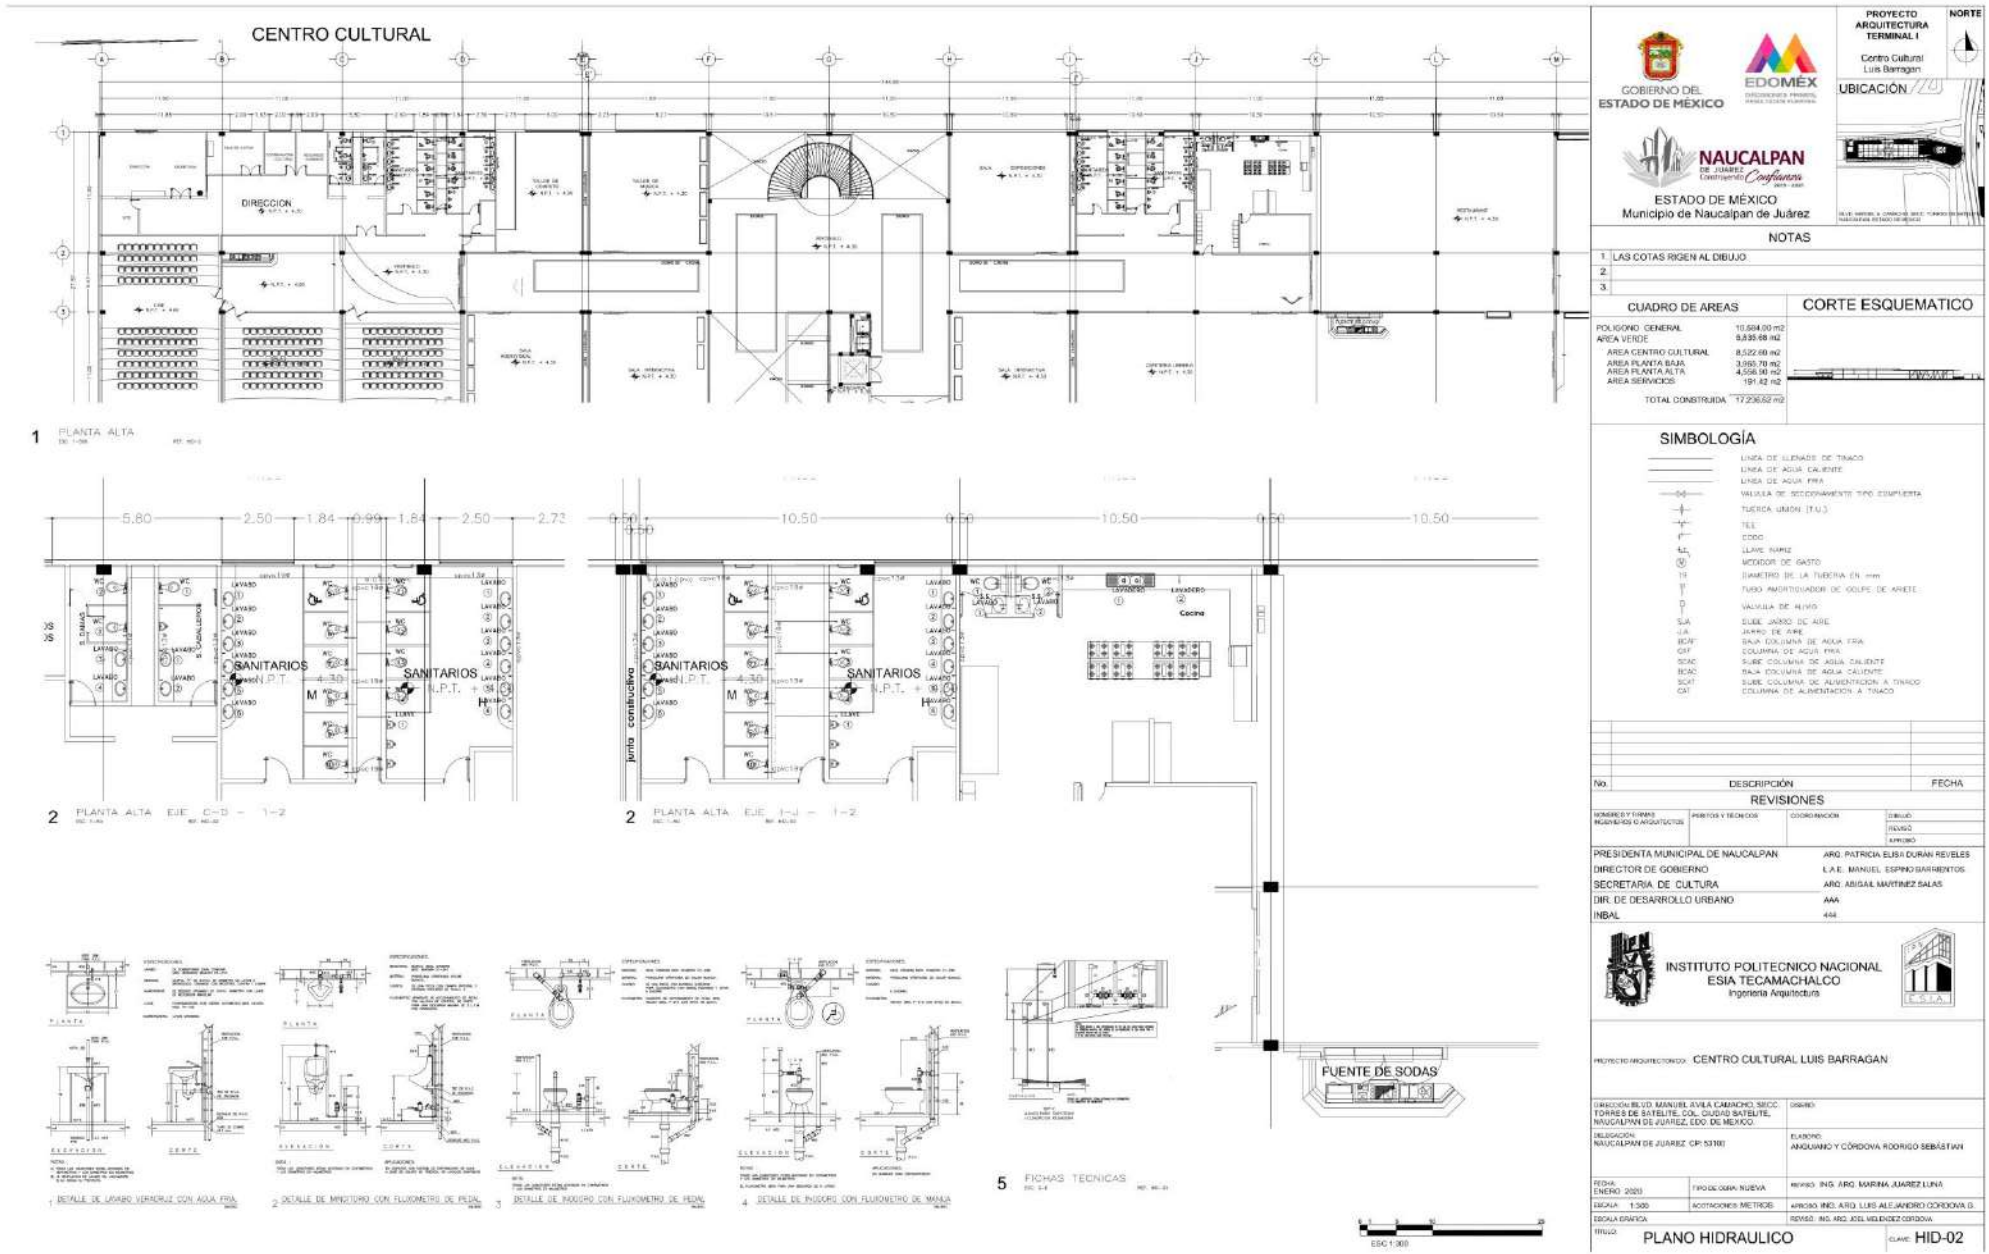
, 102, 103 PLANOS HIDRAULICOS
